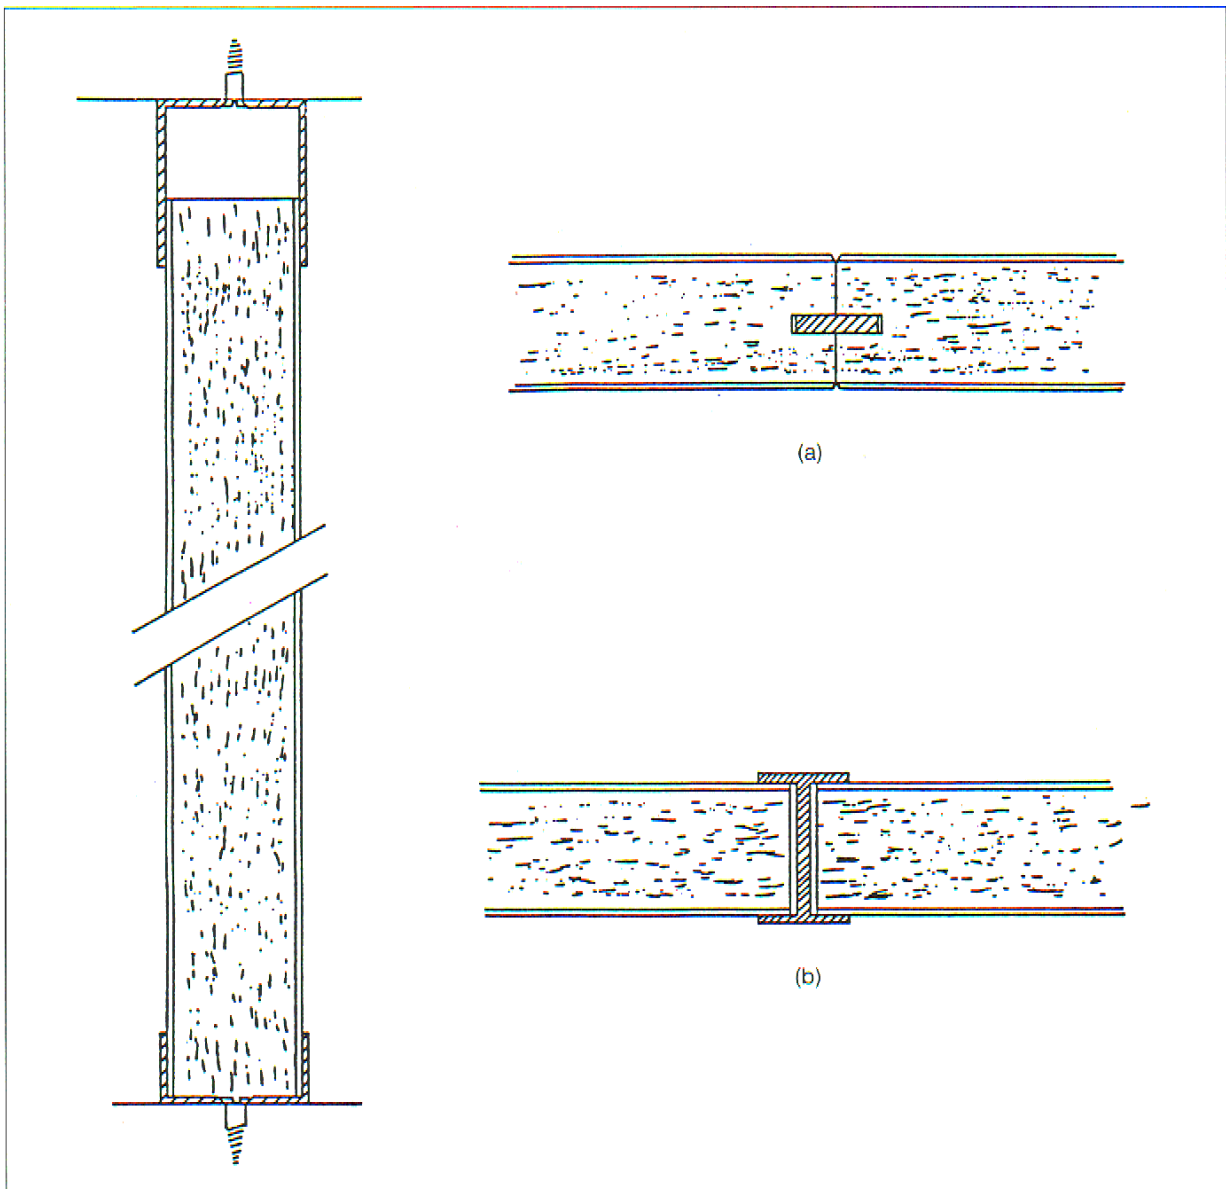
U-Profile (links), mit loser Feder (a) oder mit H-Profil (b) in den Fugen
